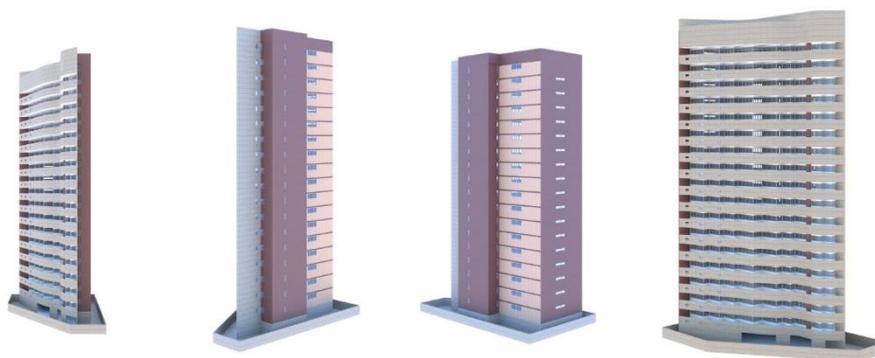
Edifício Hyde Park - visão geral das fachadas. Fonte: Adrião, 2024.
